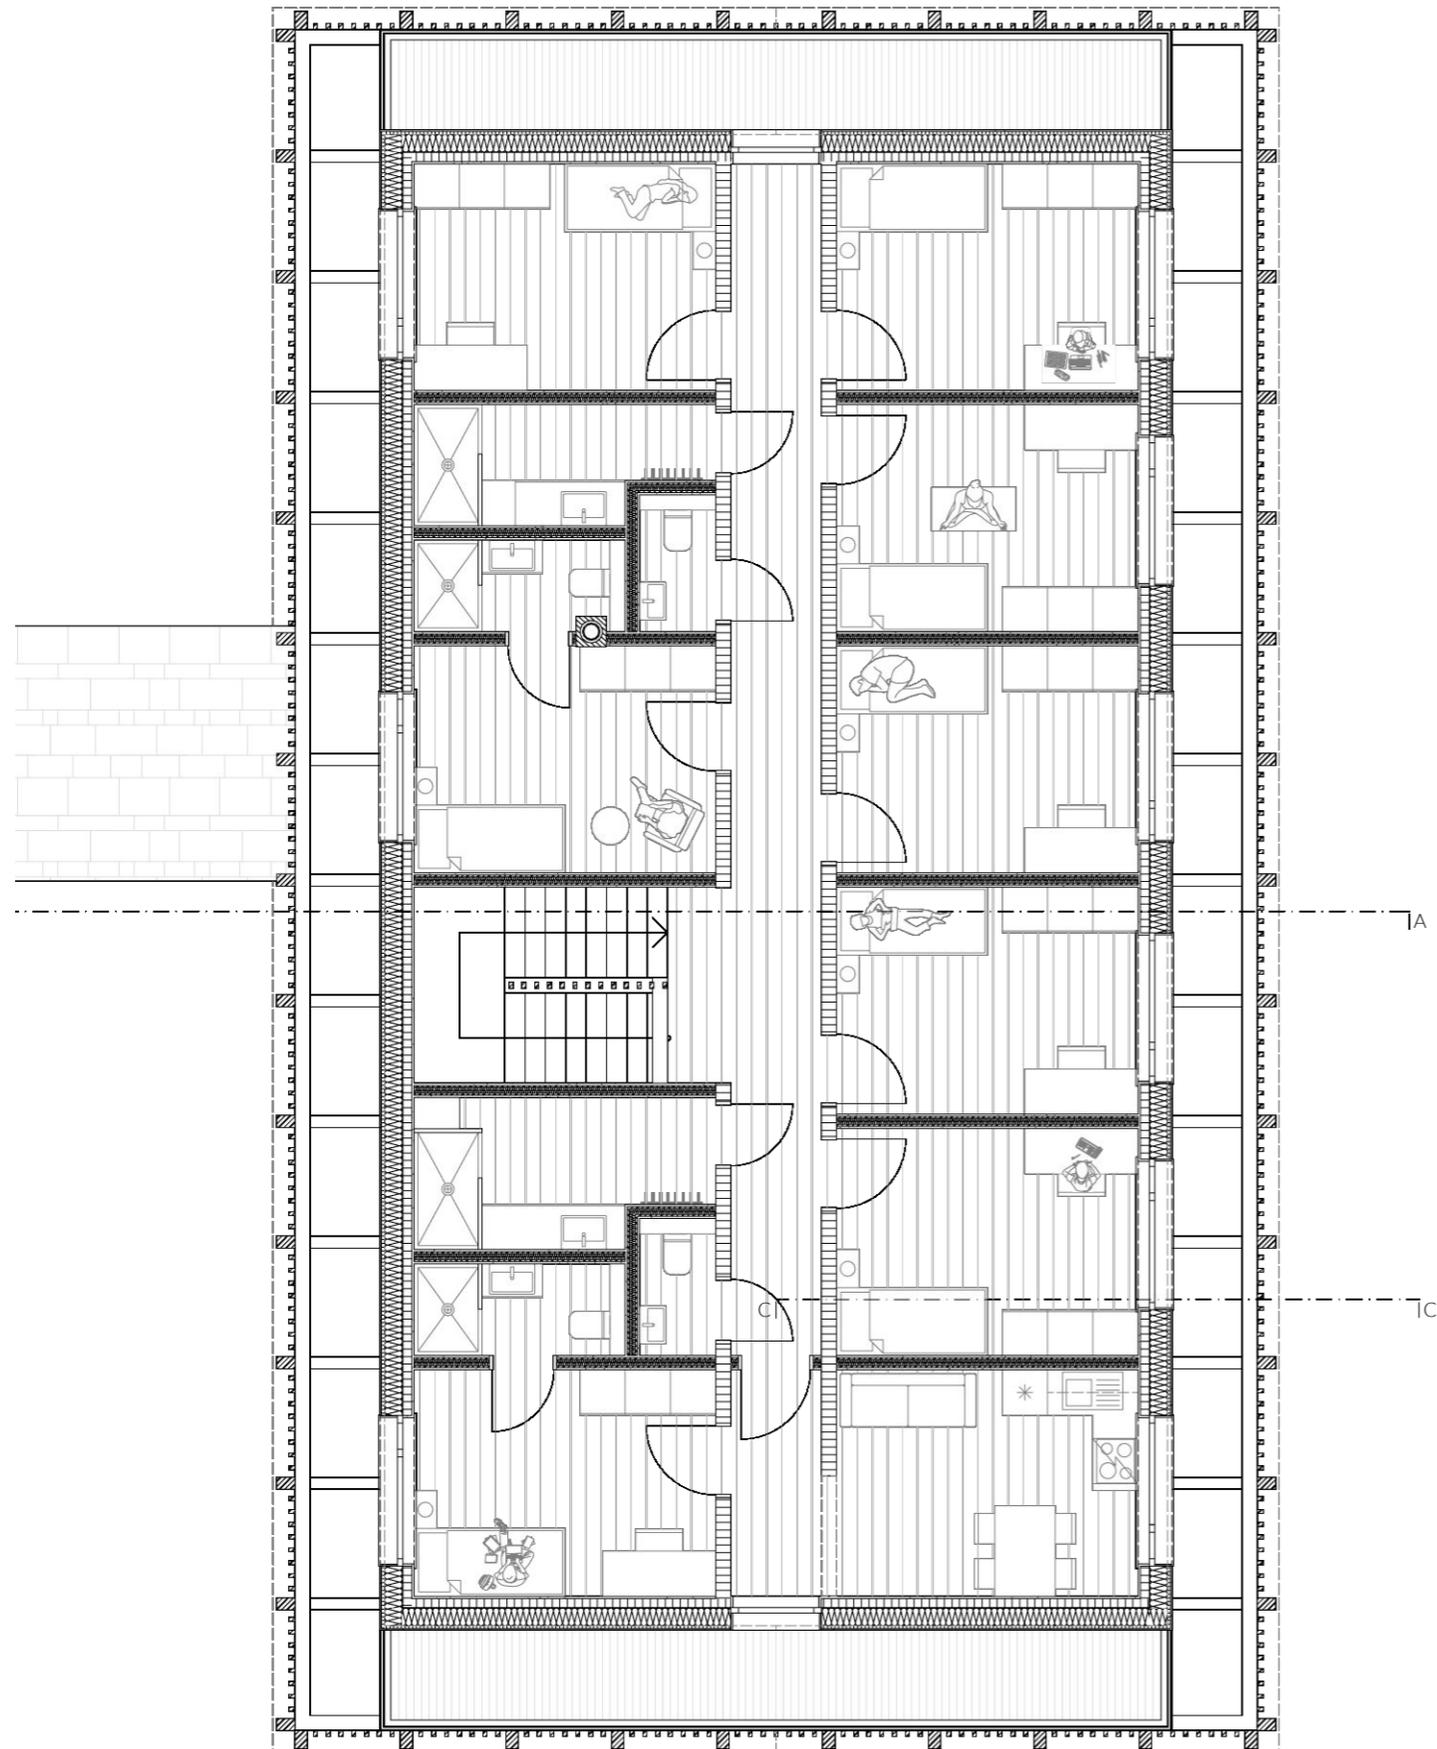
Kinderwohngruppe Grundriss Obergeschoss
